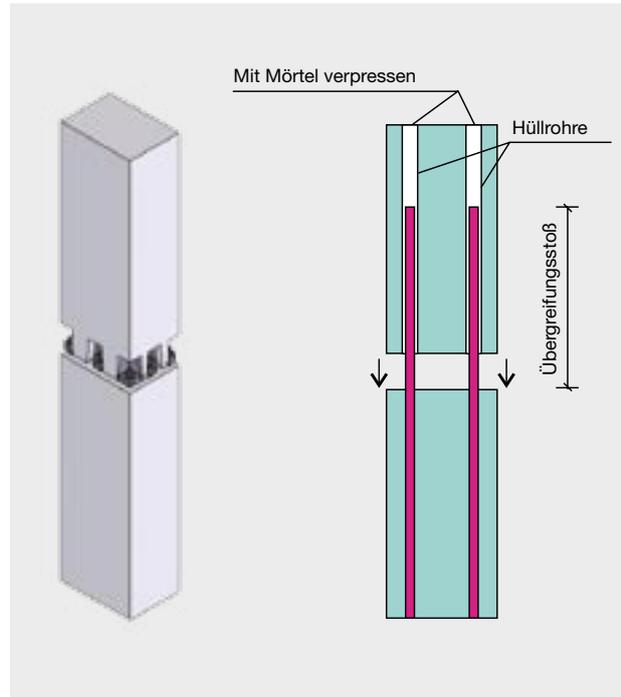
Stützenstoß mit Stützenschuhen (links) und mit Hüllrohren (rechts)
